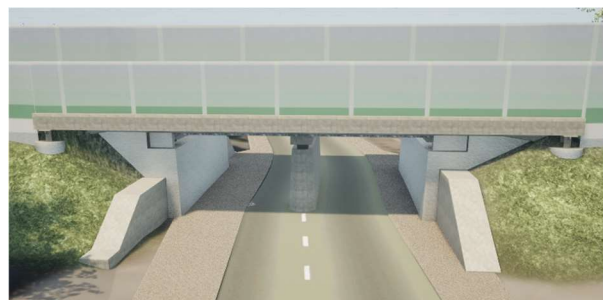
EÜ Eisenbahnstraße (Planung)
